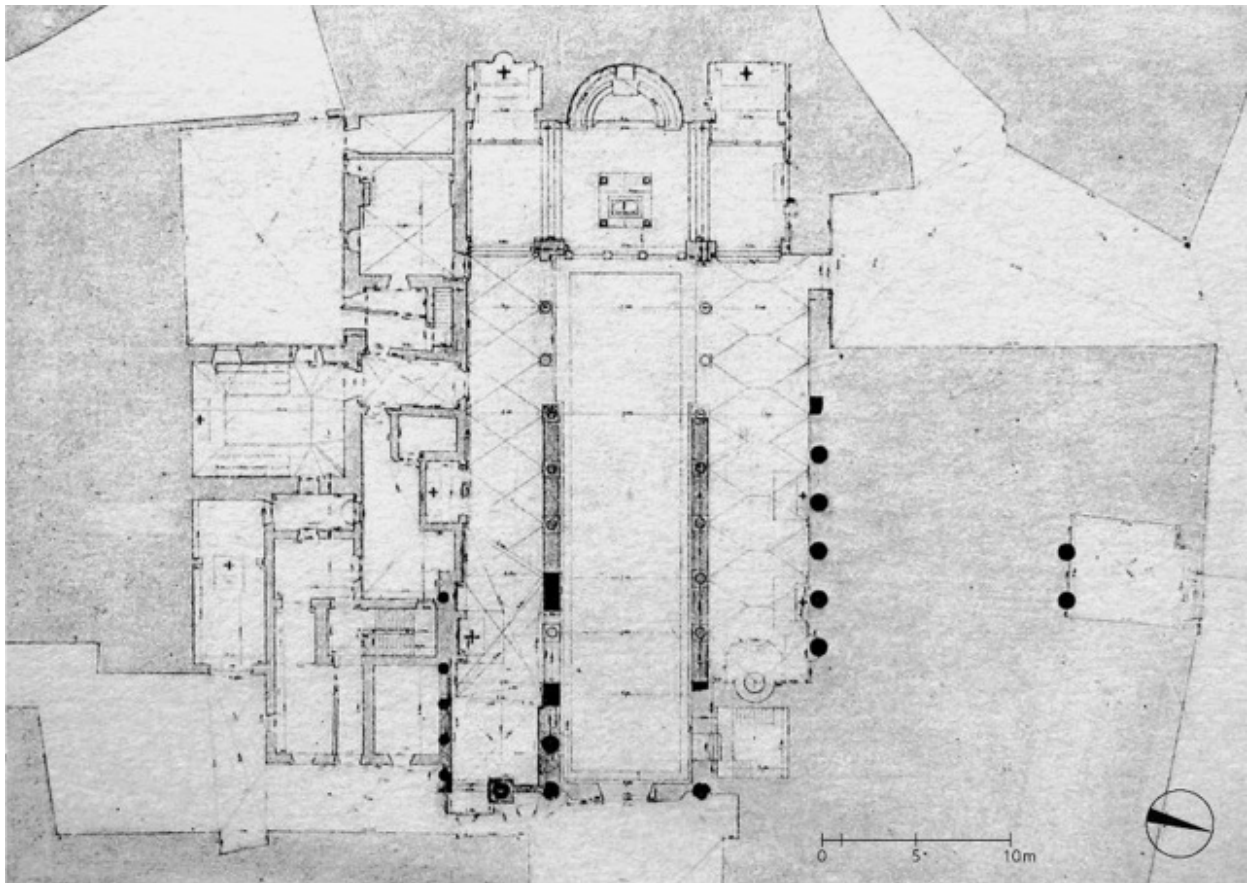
Hector Lefuel, Grundrissplan von S. Nicola in Carcere und umgebenden Gebäuden, 1843 (D'Espouy 1843)
